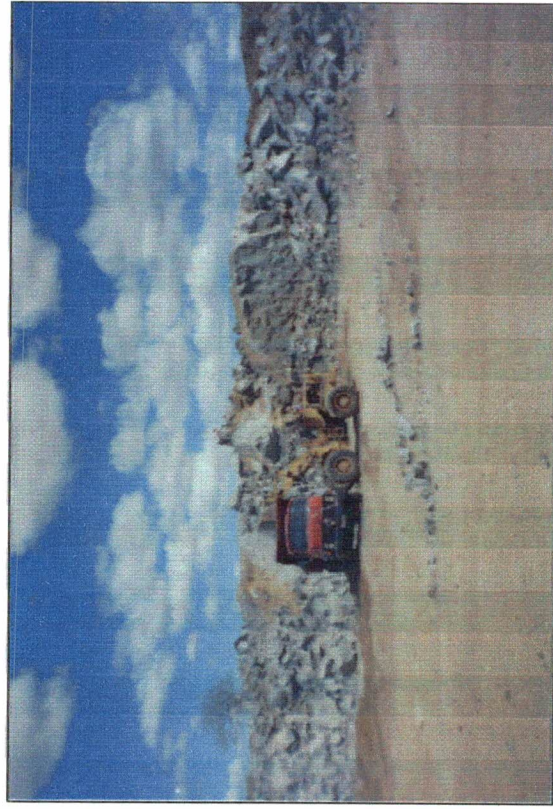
Pedreira JP-4 em fase de exploração.
